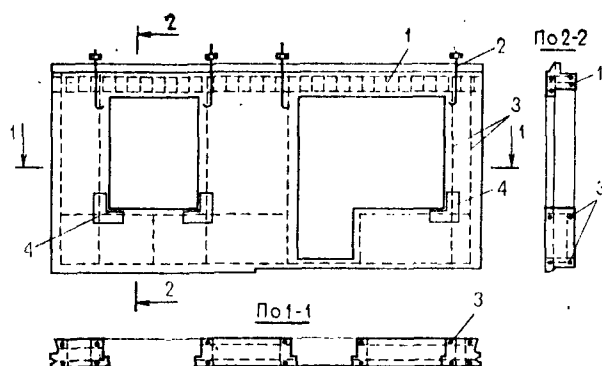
Схема армирования однослойной легобетонной панели наружной стены
